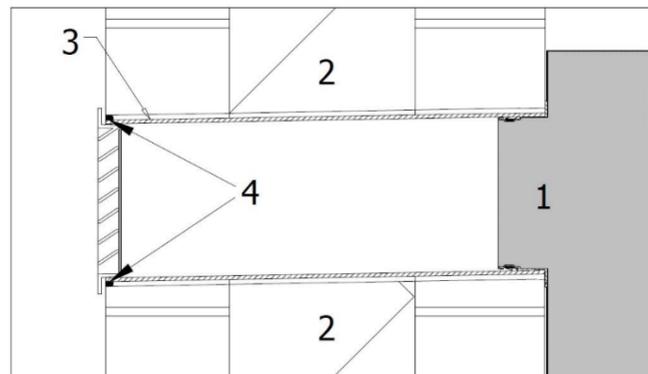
Abdichten der Fugen rund um die Kanäle, Schnittzeichnung
